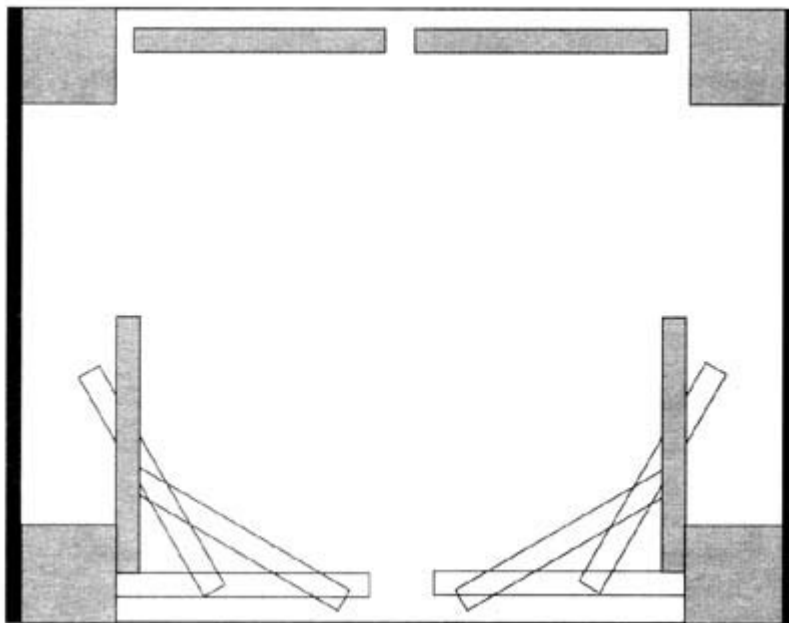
Шлюз с двухстворчатыми дверьми с плоскими поворачивающимися створками
